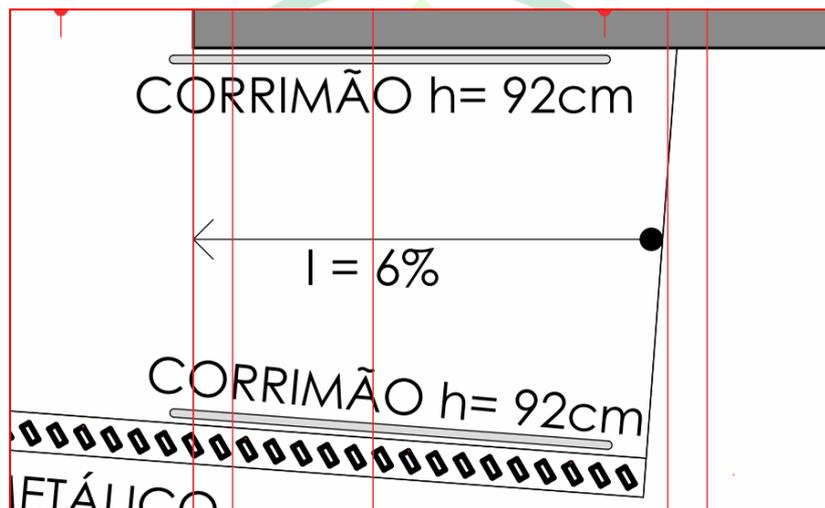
Corrimão em planta - Fonte: CEASA/PR e AUEN
